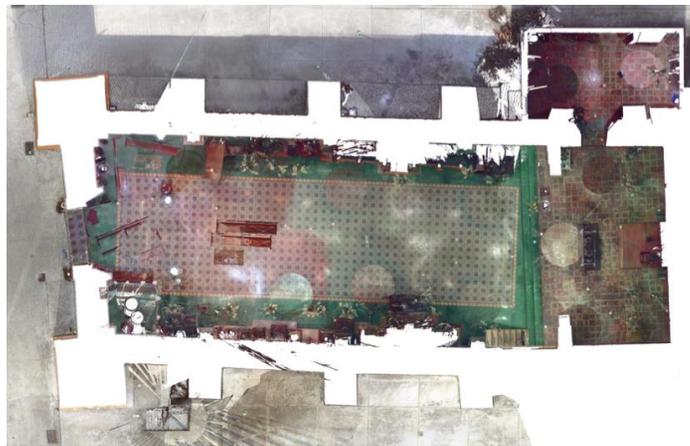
Planta arquitectónica, donde se aprecia el tapete de mosaico de pasta colocado a regla y escuadra. Obtenida del levantamiento con escáner láser. AMLG abril 2016.
